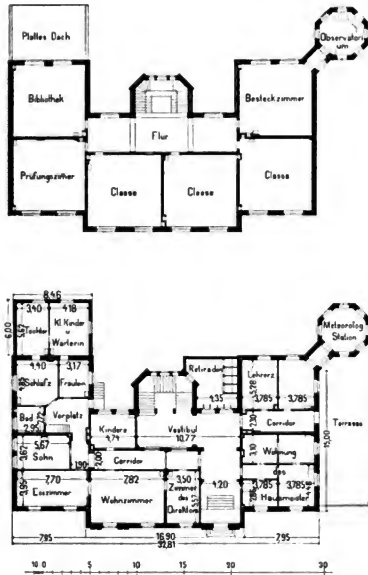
Grundriß der Seefahrtsschule Bremen.
